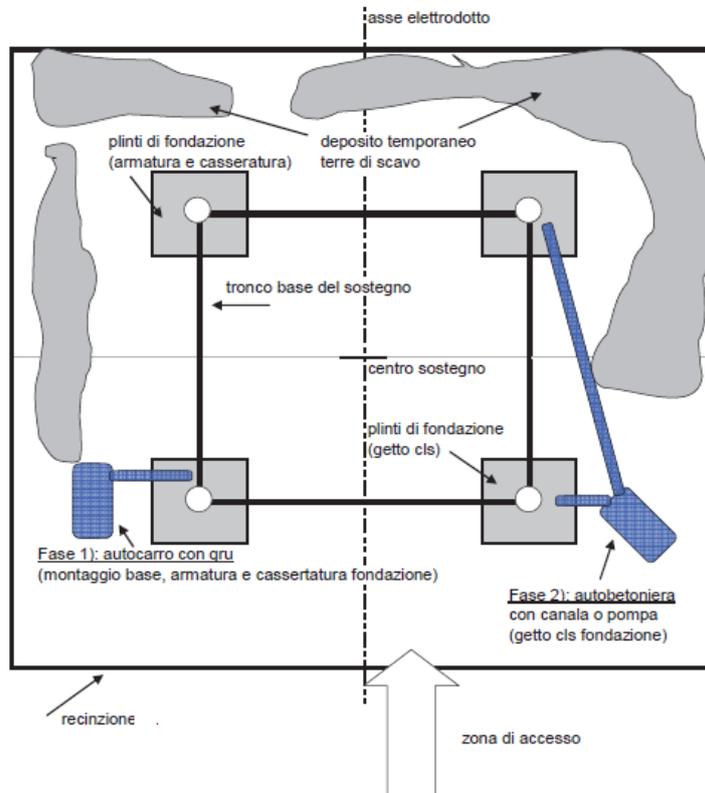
Planimetria tipologia del microcantier nella fase di getto per la realizzazione dei plinti di fondazione
